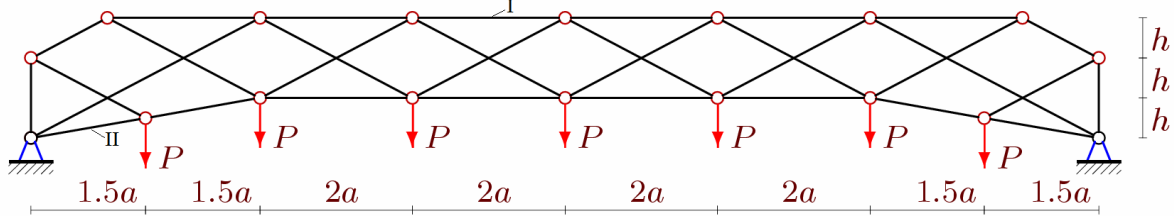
Нагрузка на нижний пояс фермы, $n = 4$
